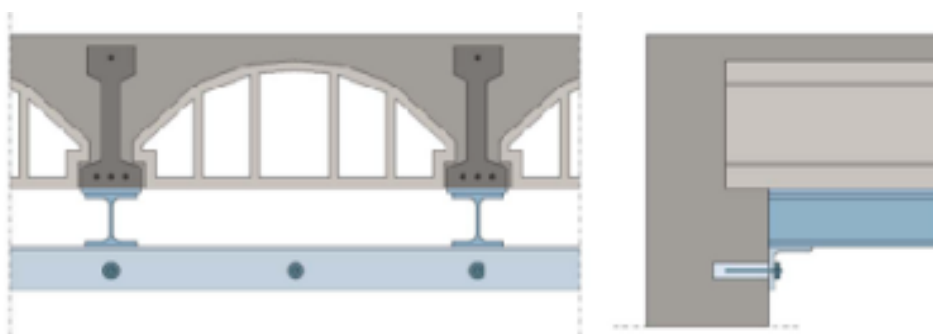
Perfiles metálicos bajo viguetas, apoyados en muro de carga
